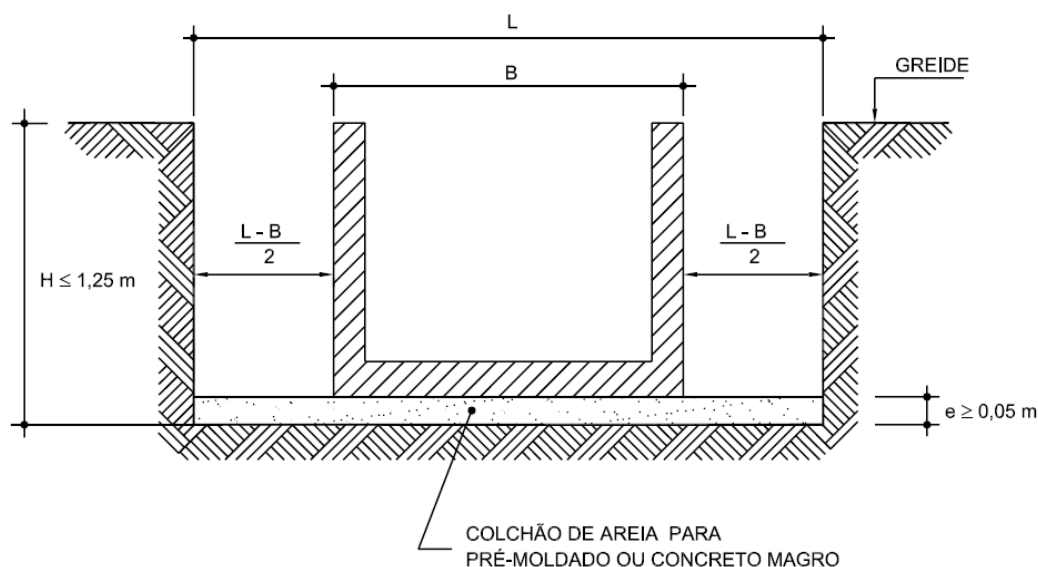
Canaleta de drenagem – caixa de escavação para profundidades até 1,25 m
